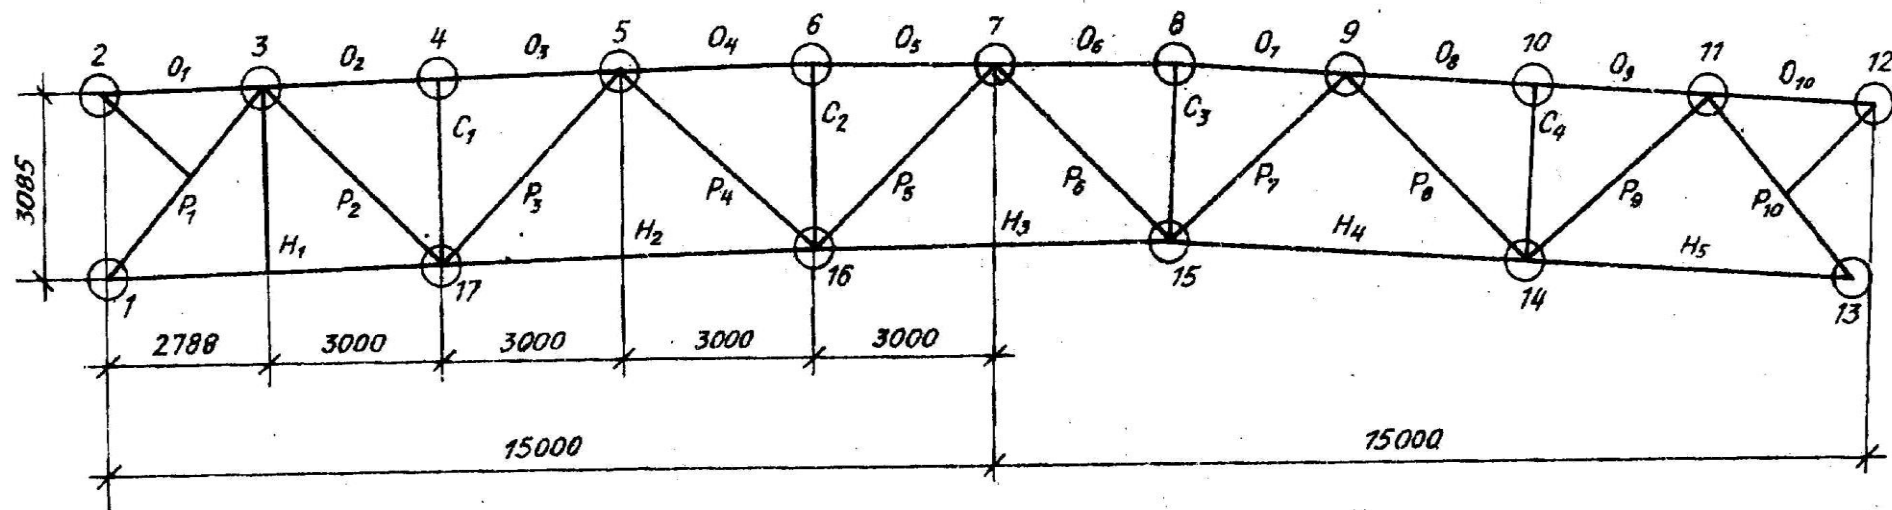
Геометрическая схема фермы ФС 30-6, 90 В; 2,50 В
